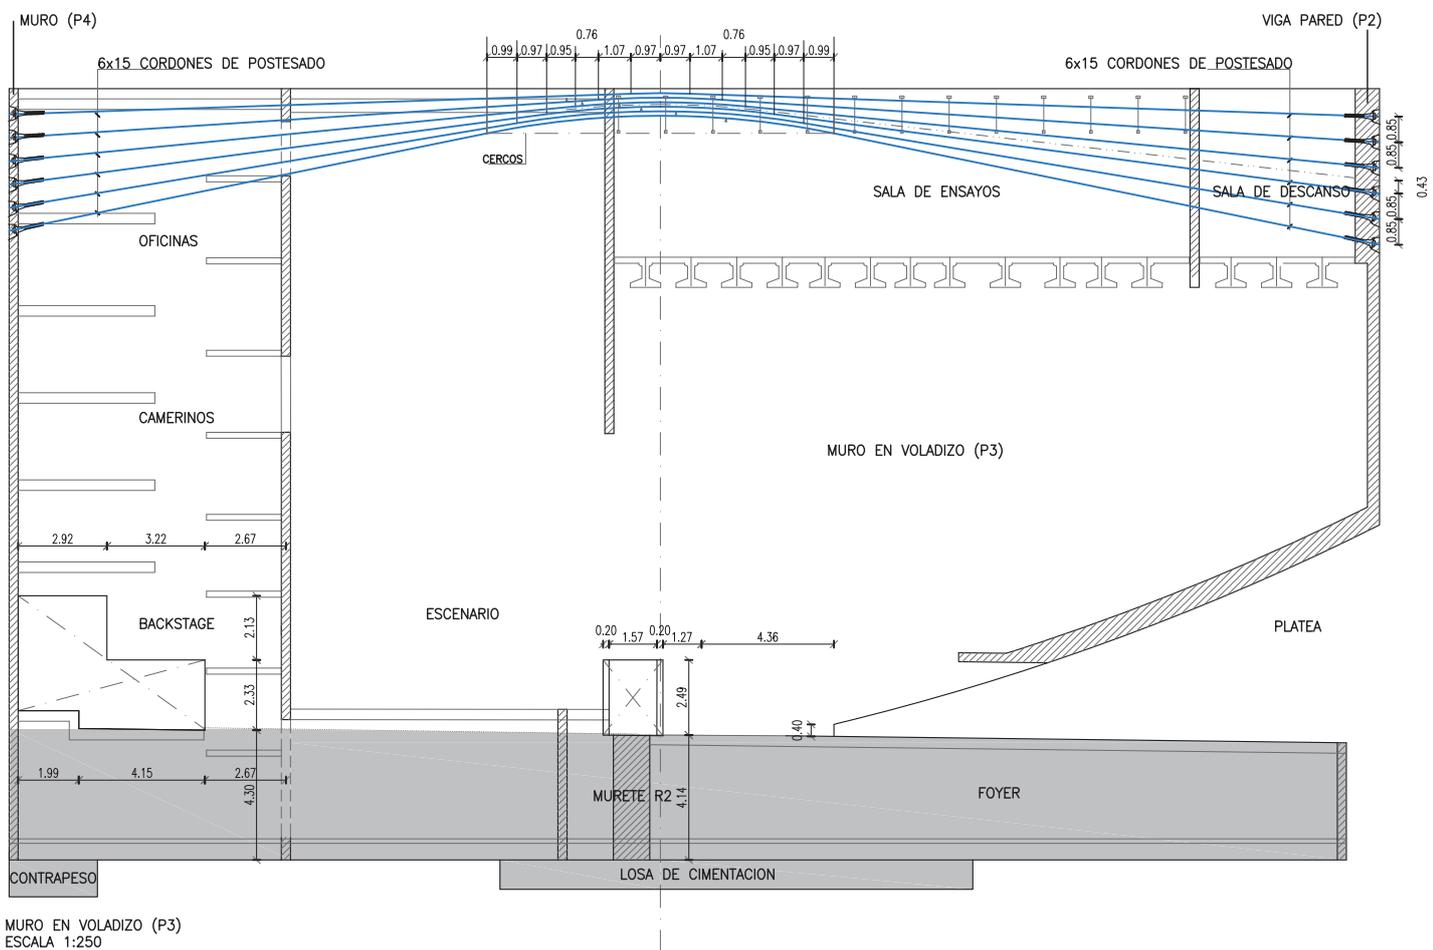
Sección 2, Alzado del muro volado P3 donde se muestran los cables de postesado y su trazado a lo largo del muro. Escala 1:250 [27]
